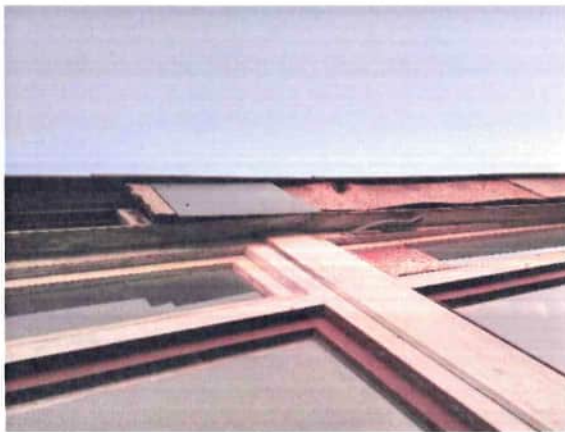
Ansicht des Dachabschlusses mit Zugangsmöglichkeiten ins Gebäudeinnere und Quartierpotenzial des Gebäude D, Detailansicht (09.04.2020).
